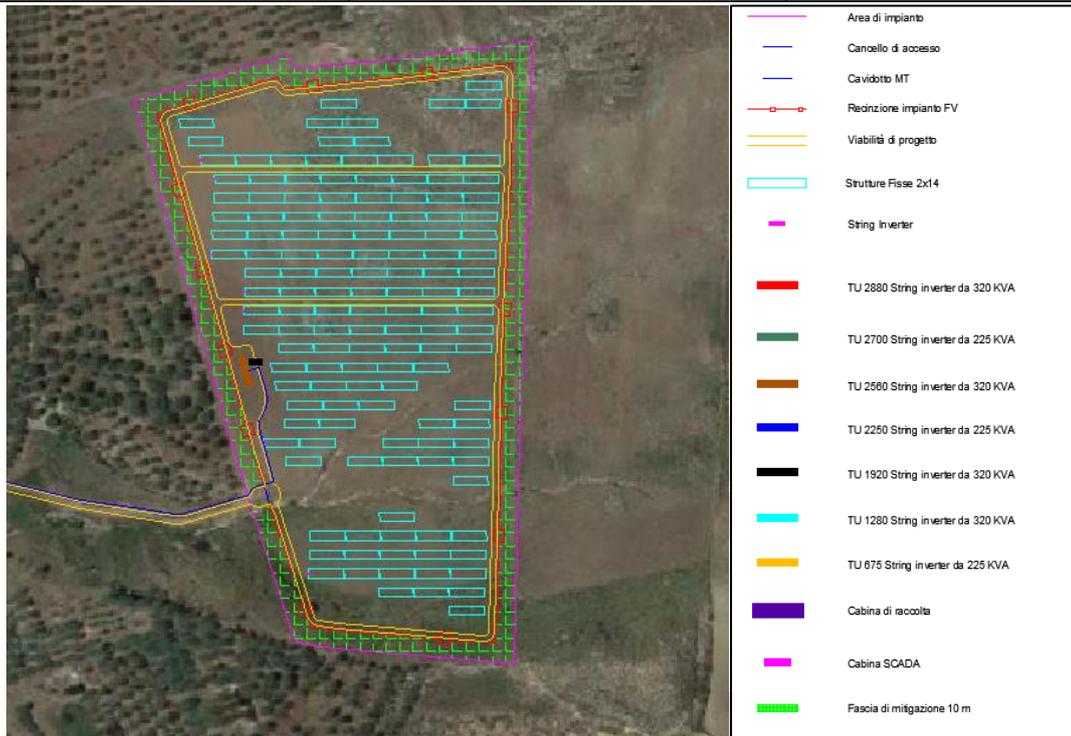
Sovrapposizione su ortofoto del layout di impianto – Lotto 6
